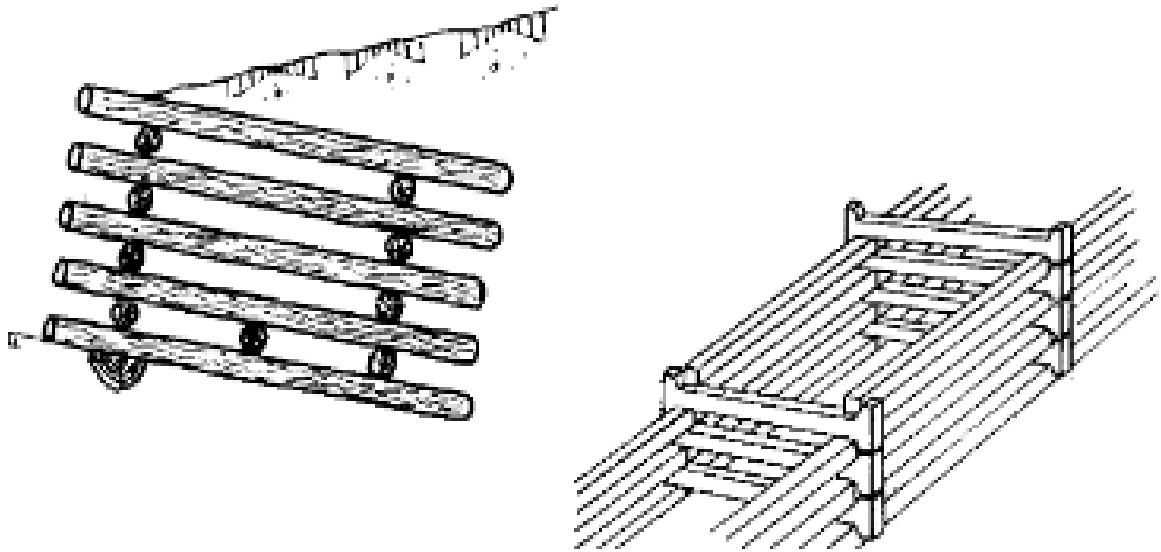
a). Muro criba realizado con tronco de árbol, b) muro criba de hormigón
